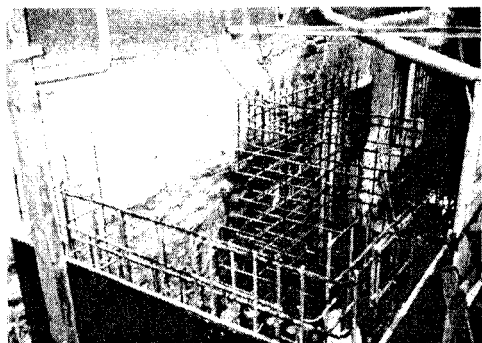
Армування фундаментів сходової клітки та шахти ліфта
